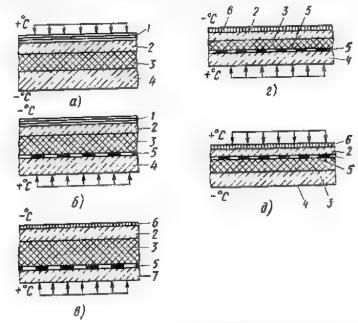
Схемы тепло- и пароизоляции зданий холодильников:
